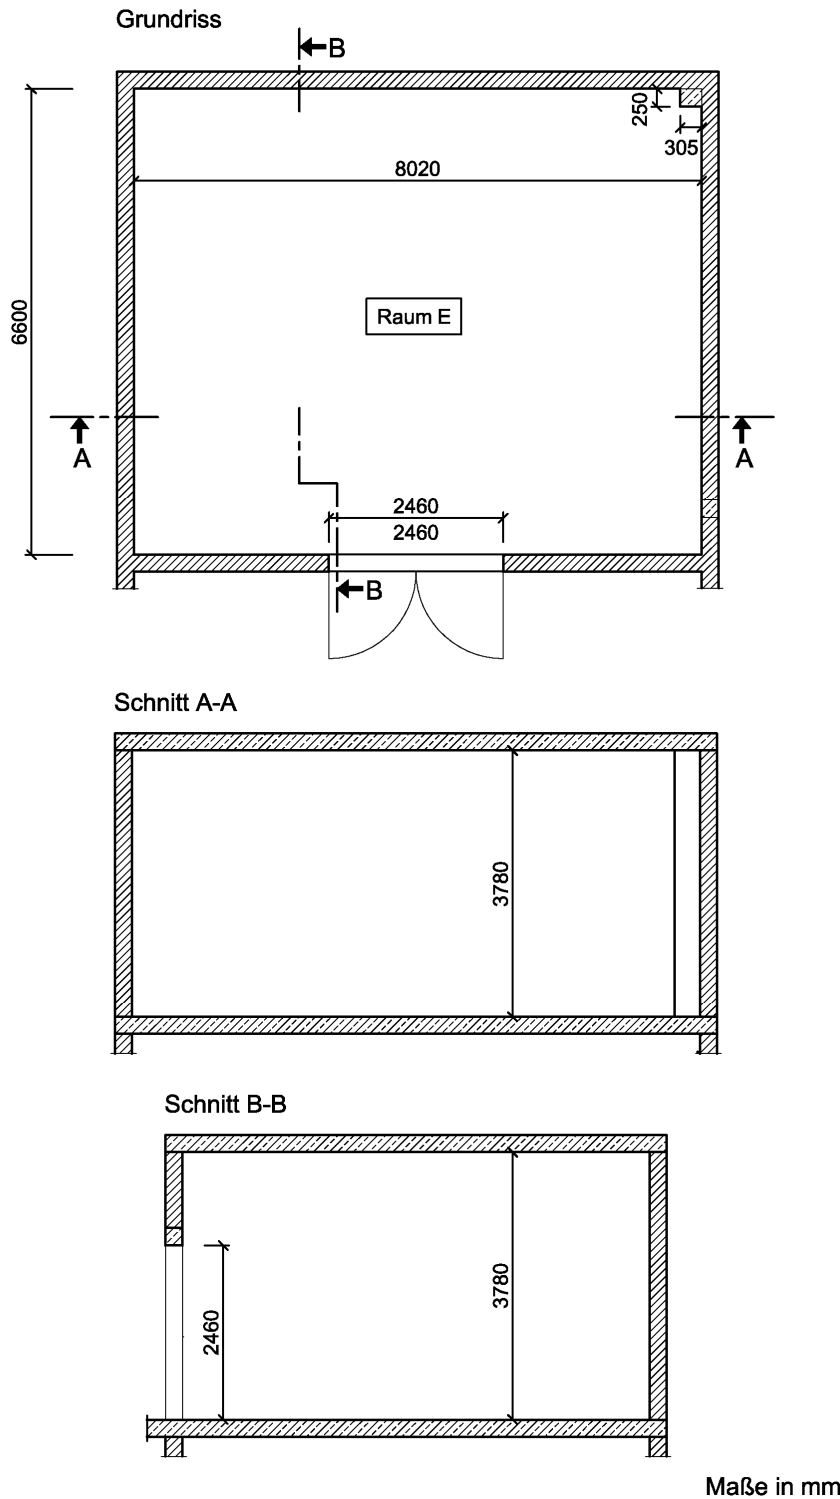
Grundriss und Schnitte des Hallraums.
